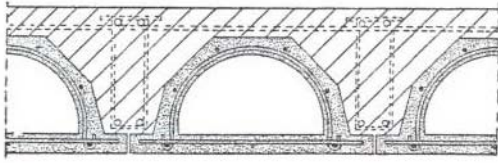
Betonvloerplaat gestort op holle bekistingselementen [1]
